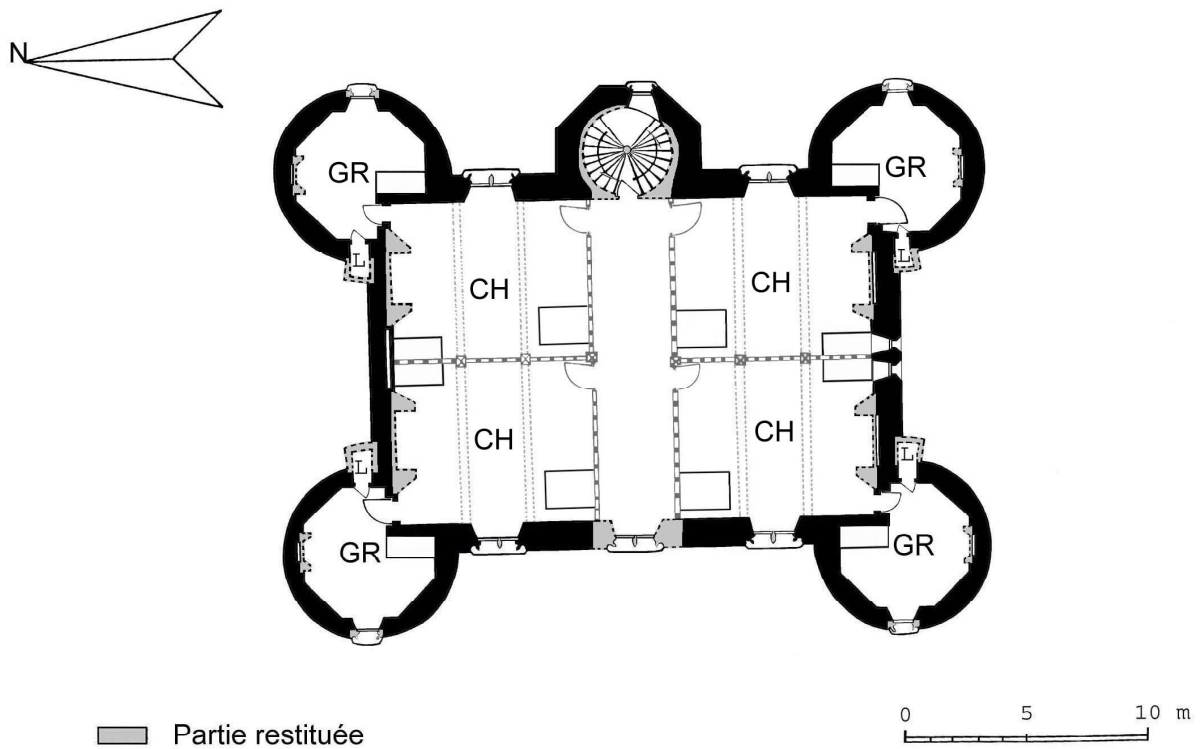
Martainville. Plan restitué du premier étage vers 1495.
